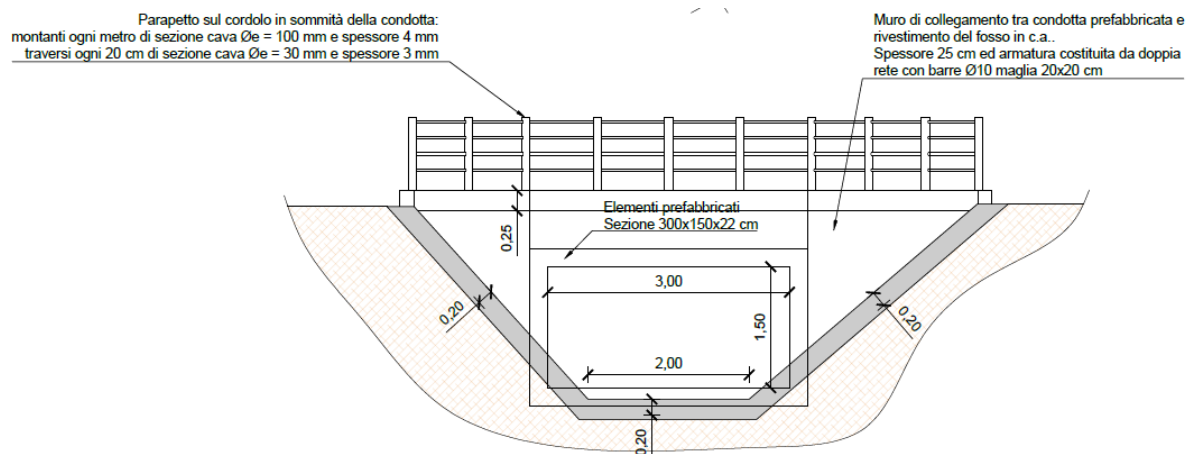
parapetto a protezione dello sbocco dell'attraversamento della S.P. n.152
